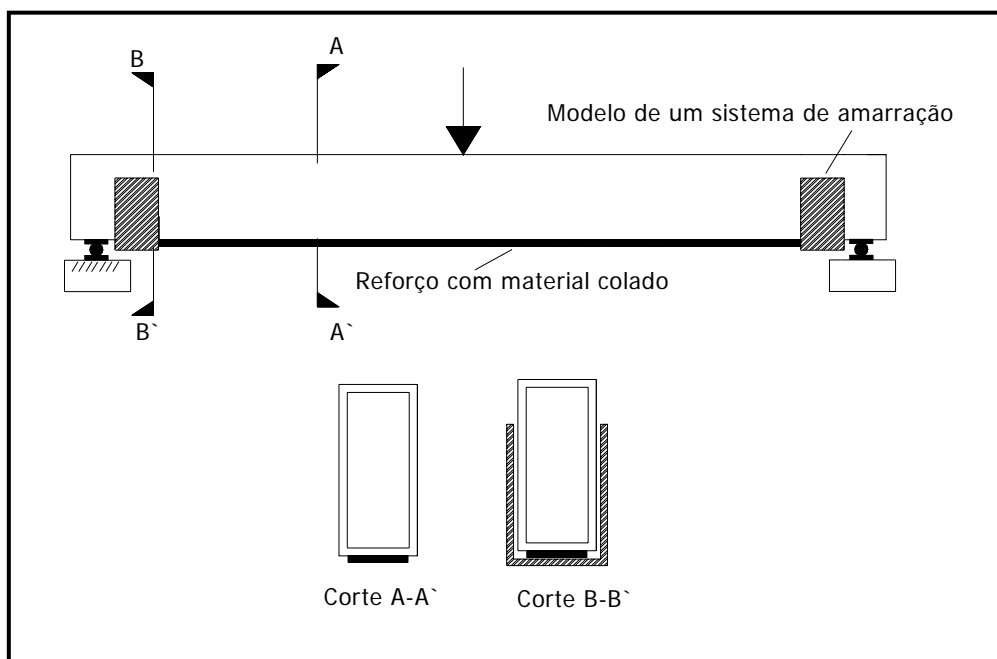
Reforço à flexão de vigas por materiais colados com um sistema de amarração.
